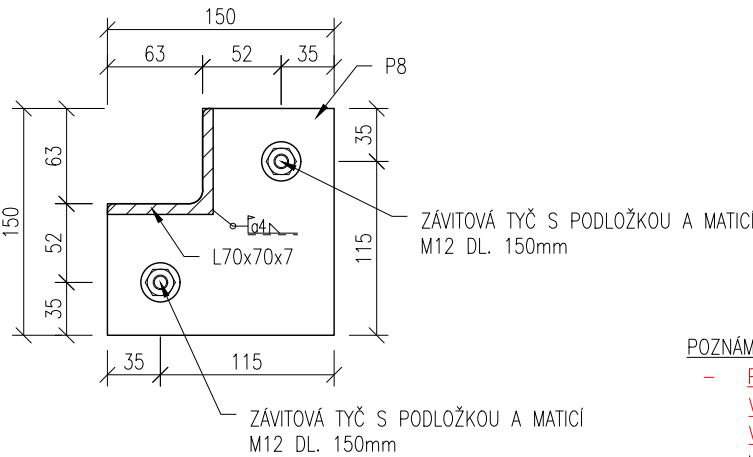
NADPRAŽÍ ŠACHETNÍCH DVEŘÍ
